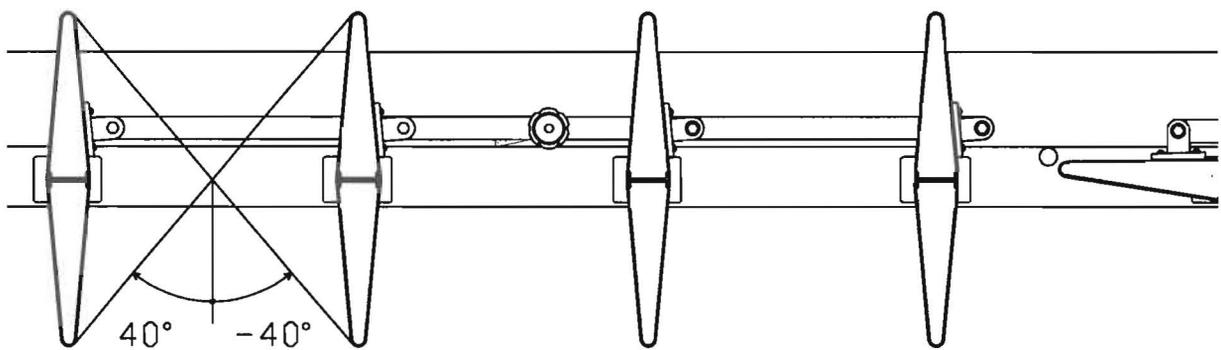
Vista en planta de los sistemas pivotantes verticales de protección solar en posición perpendicular a la fachada.
